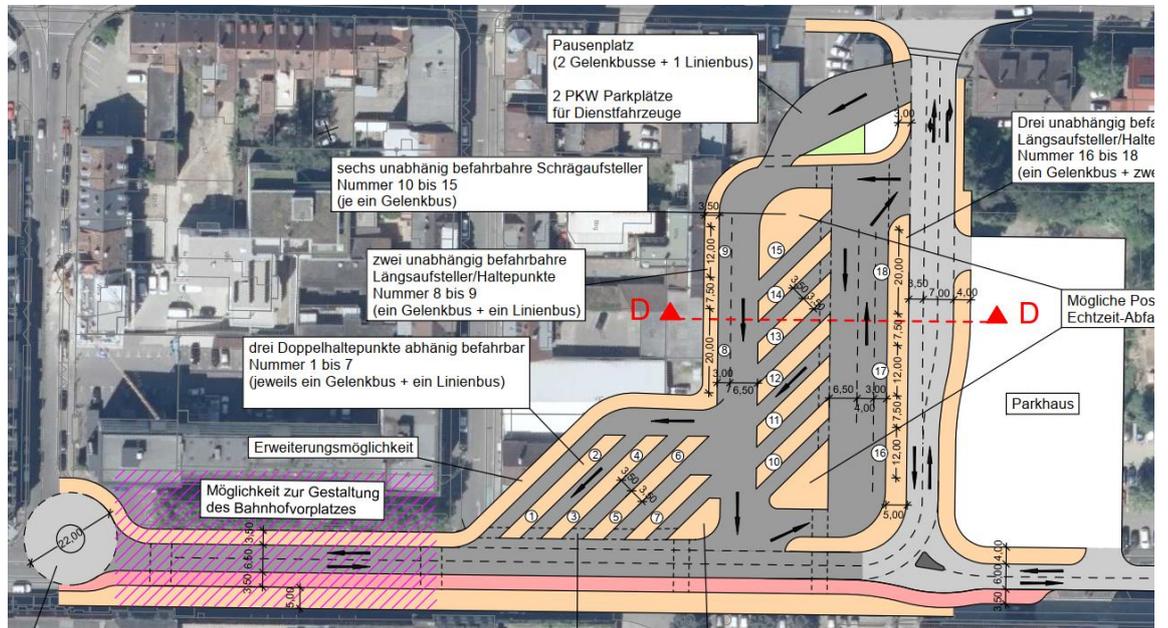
Ausschnitt Lageplan Nordverlegung 3
